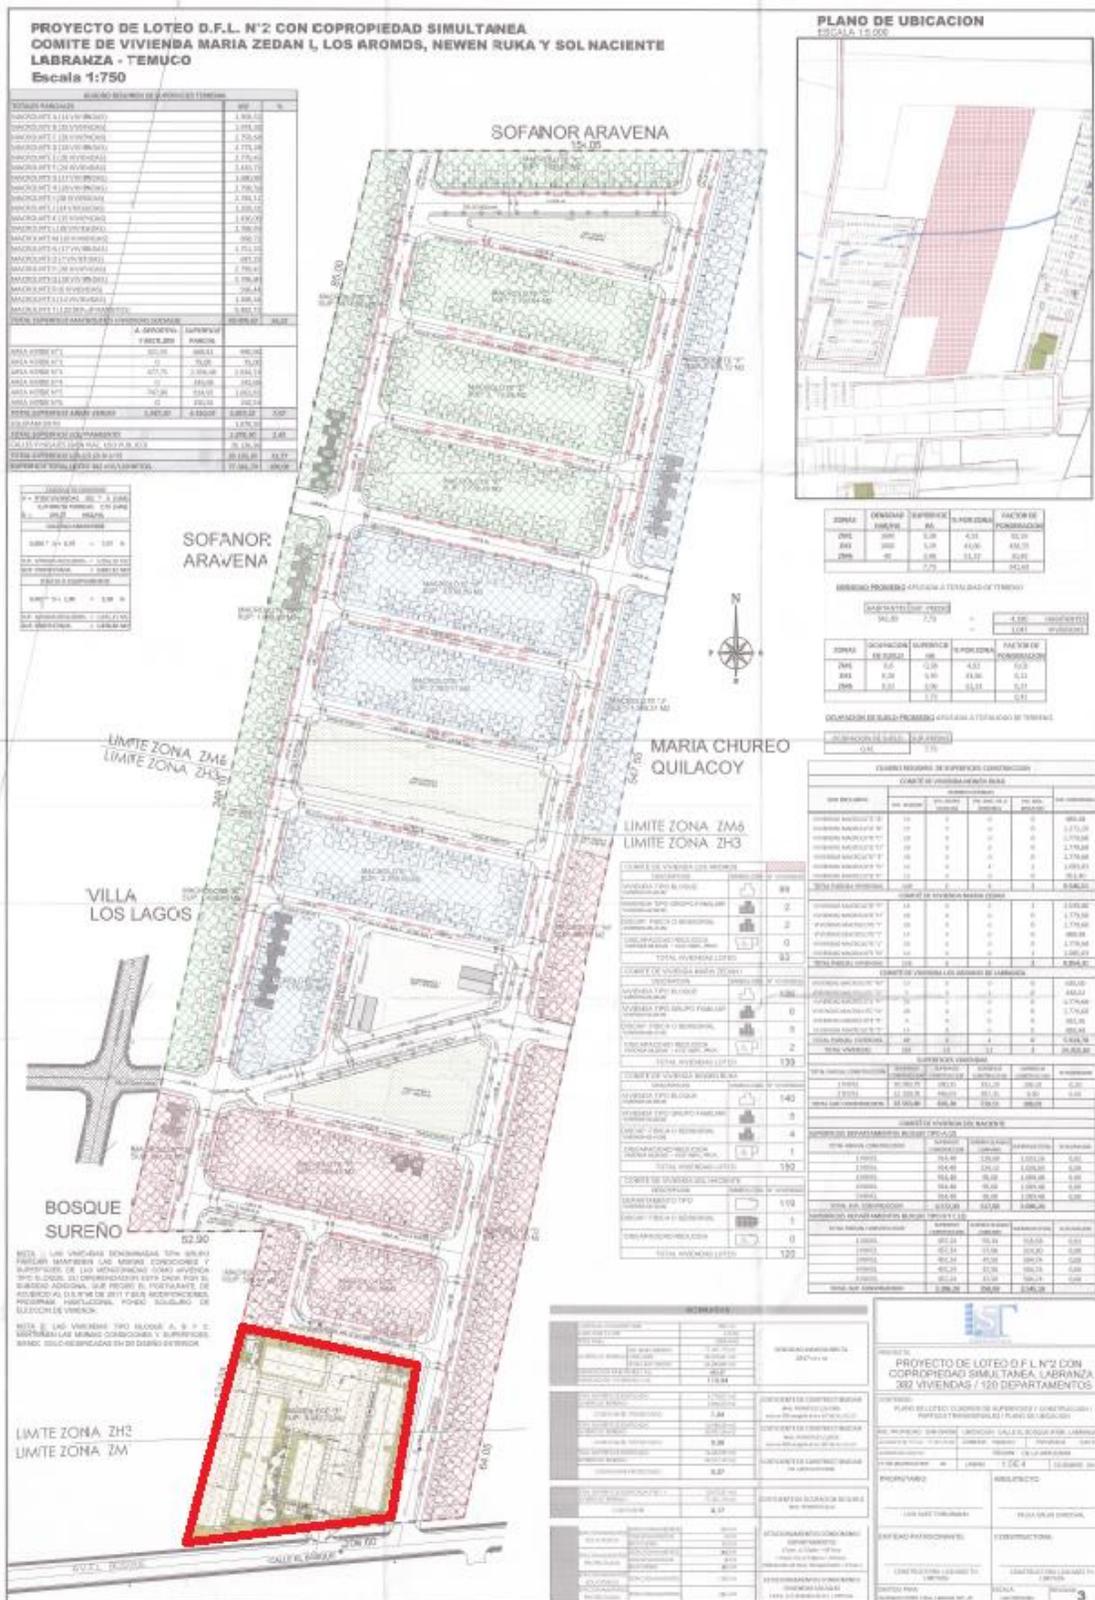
Plano de loteo de conjunto habitacional de Labranza
